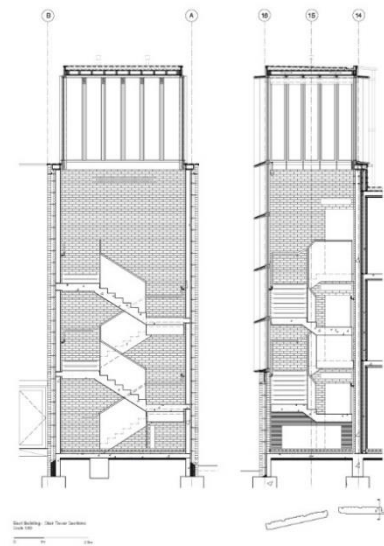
Cortes del cubo de escaleras del edificio este, FUENTE: Arch Daily
